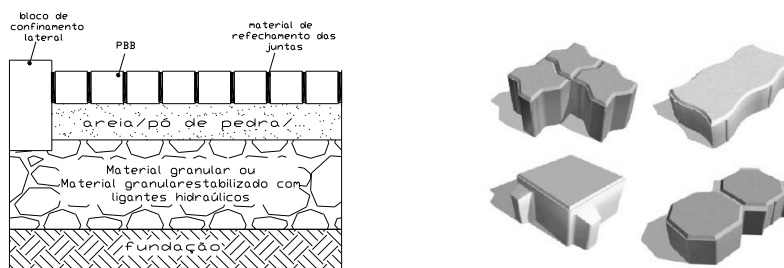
Perfil transversal tipo de um pavimento em BPB e formato dos BPB (Pre14)
